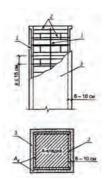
Схема усиления железобетонной обоймой. 1 – стержни диаметром 5 – 12 мм; 2 – хомуты диаметром 4 – 10 мм; 3 – бетон класса B7,5 – B25.
